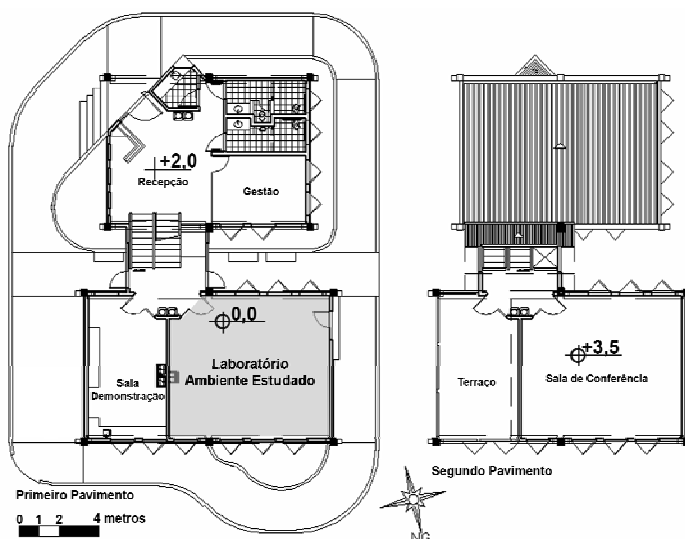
Plantas do Primeiro e Segundo Pavimentos do CPEI.
